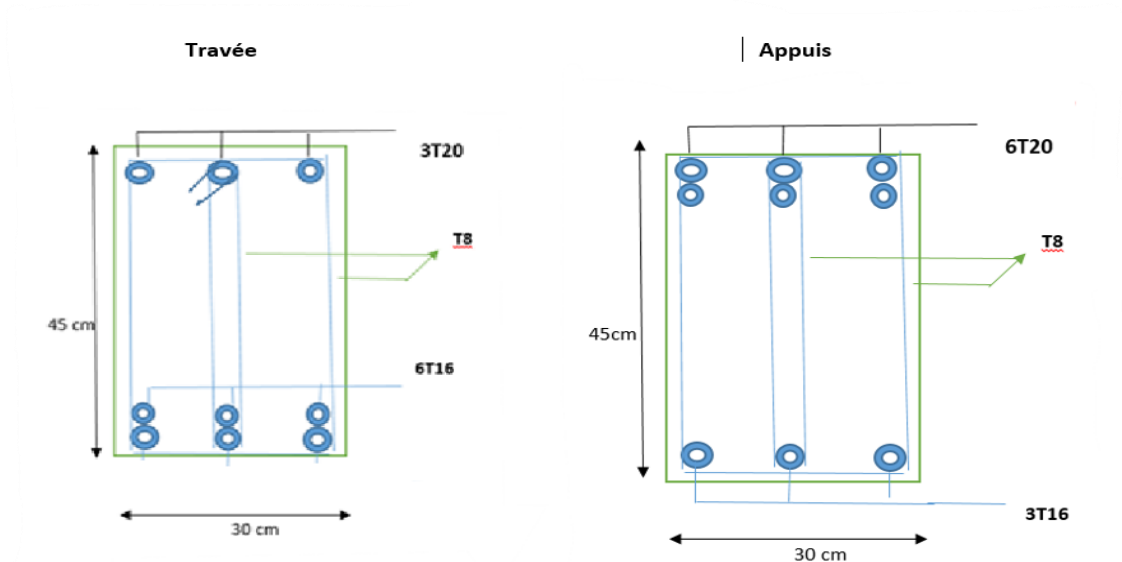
Schéma de ferrailage des poutres non porteuses.
